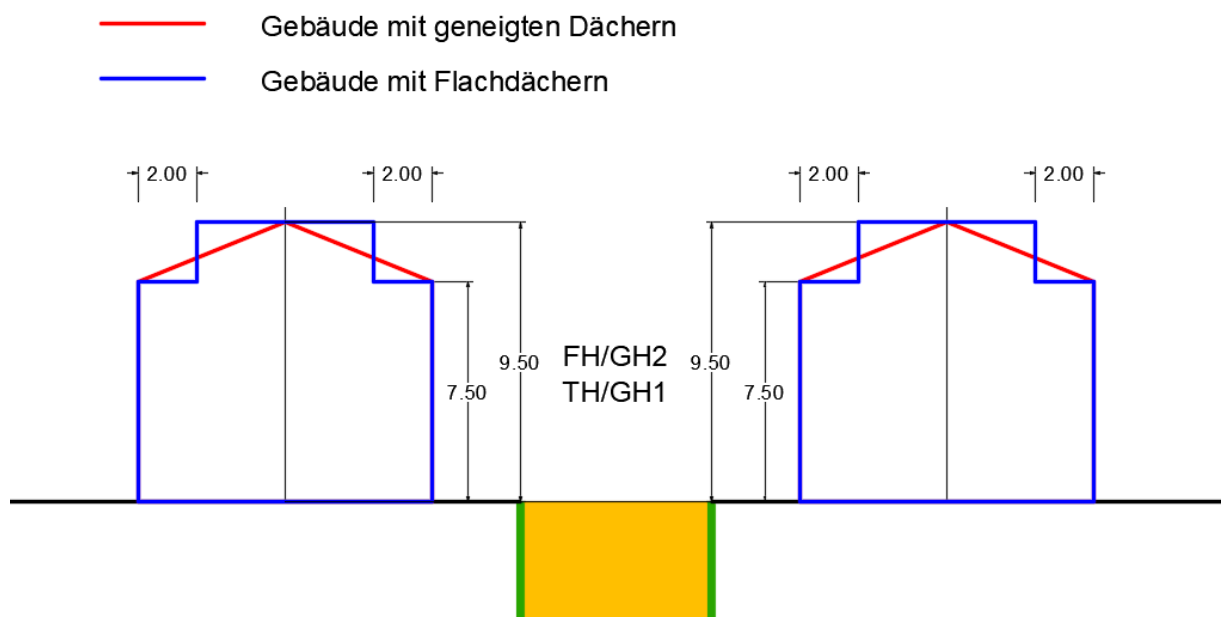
Darstellung der maximalen Traufhöhe/ Firsthöhe/ Gebäudehöhe 1/ Gebäudehöhe 2 bei Gebäuden mit geneigten Dächern/ Gebäuden mit Flachdächern im Bereich FG.
